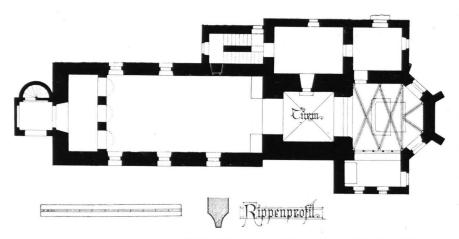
Kirchberg a. d. Wild, Pfarrkirche, Grundriß 1:300 (S. 147)
